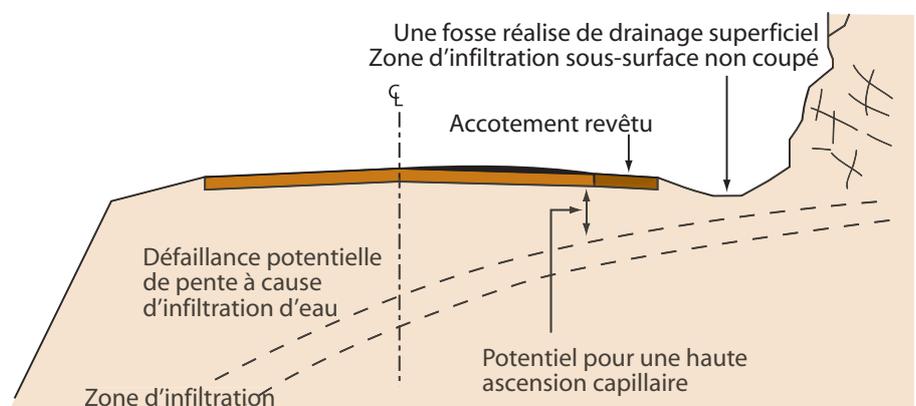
Défauts typiques de drainage associés avec des sections déblai/remblai de chaussées¹³
